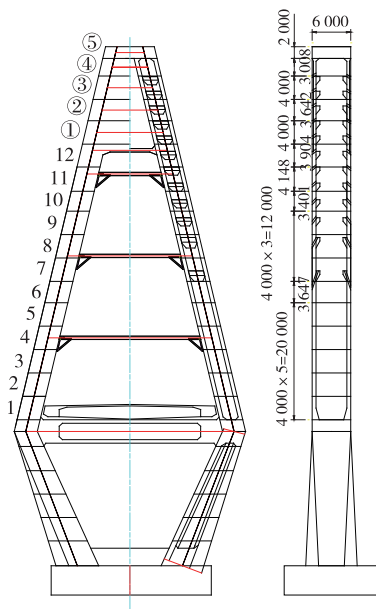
丁字河口大桥主塔上塔柱施工分段示意图(单位:mm)
